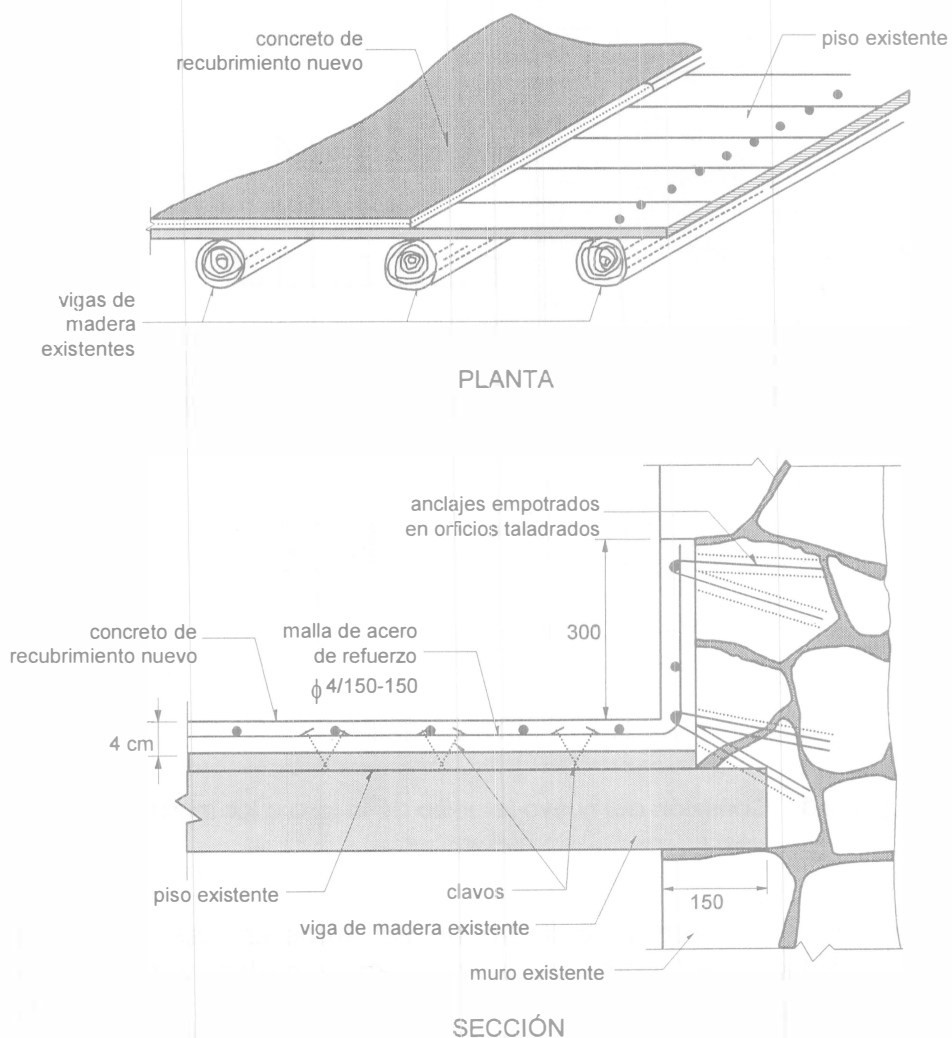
Incremento de la rigidez en el plano de sistemas de piso/techo usando madera o concreto.
